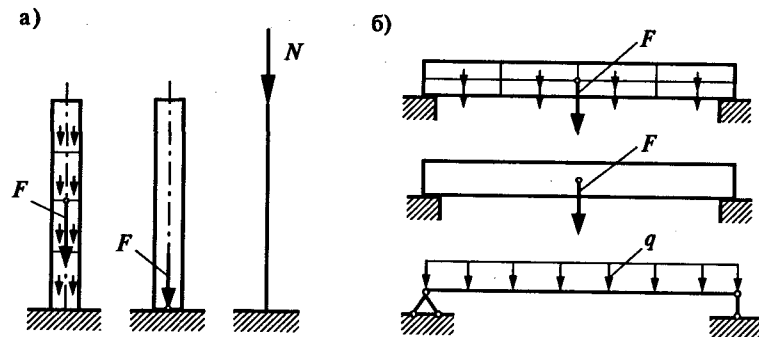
Нагрузки от собственного веса конструкций:
